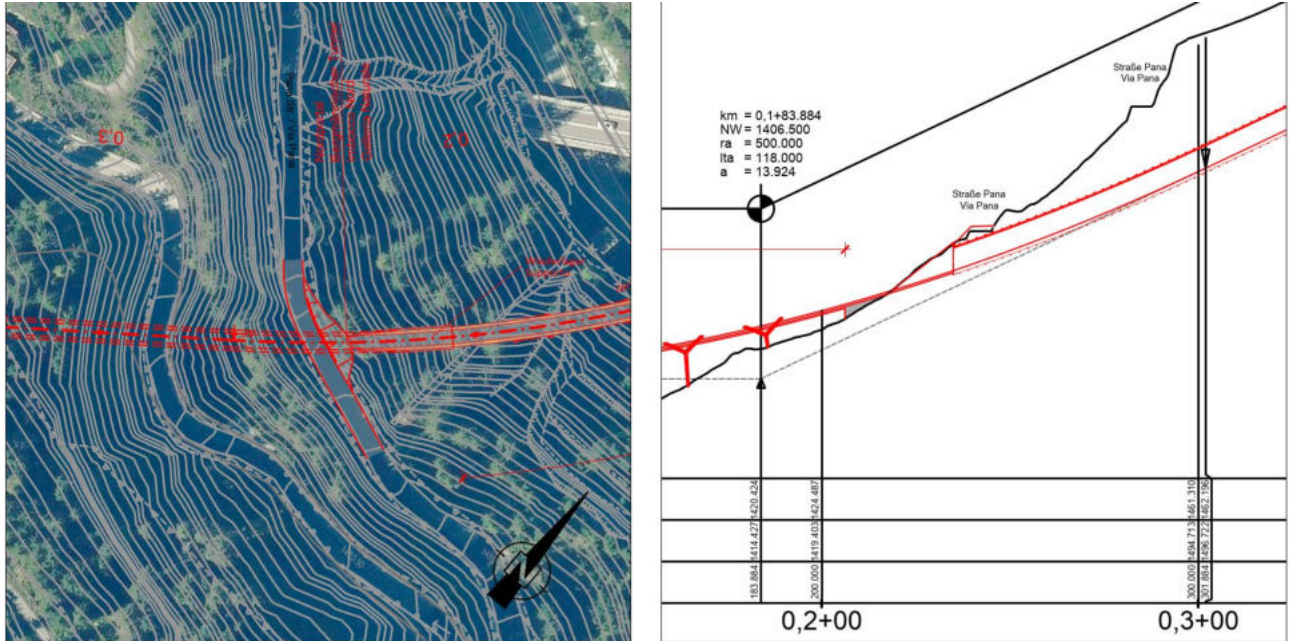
Auszug Lageplan und Längenschnitt Unterquerung Pana Straße Bereich Norportal
